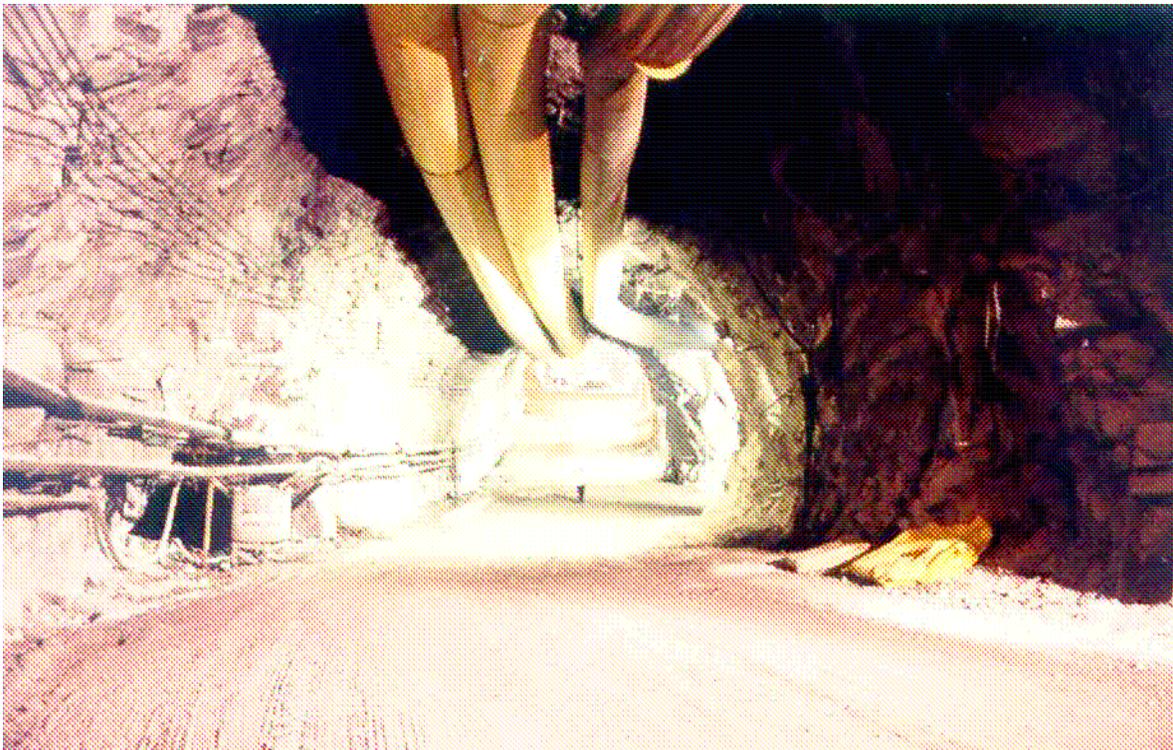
Túnel de acceso a la casa de máquinas similar al que se construirá en La Yesca (vista)
